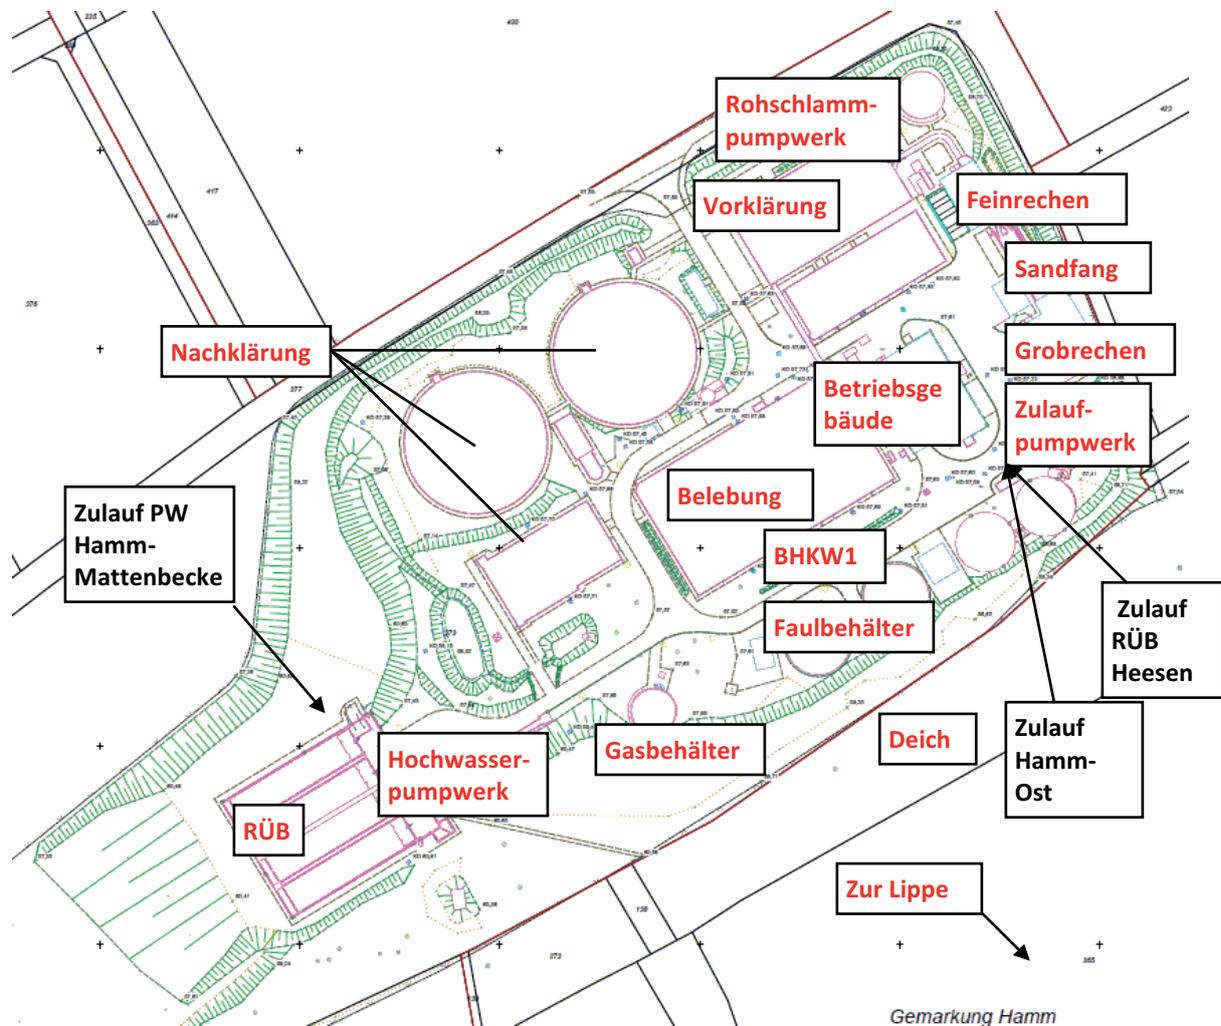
Lageplan der Kläranlage Hamm-Mattenbecke [nach Lippeverband, 2008b]
